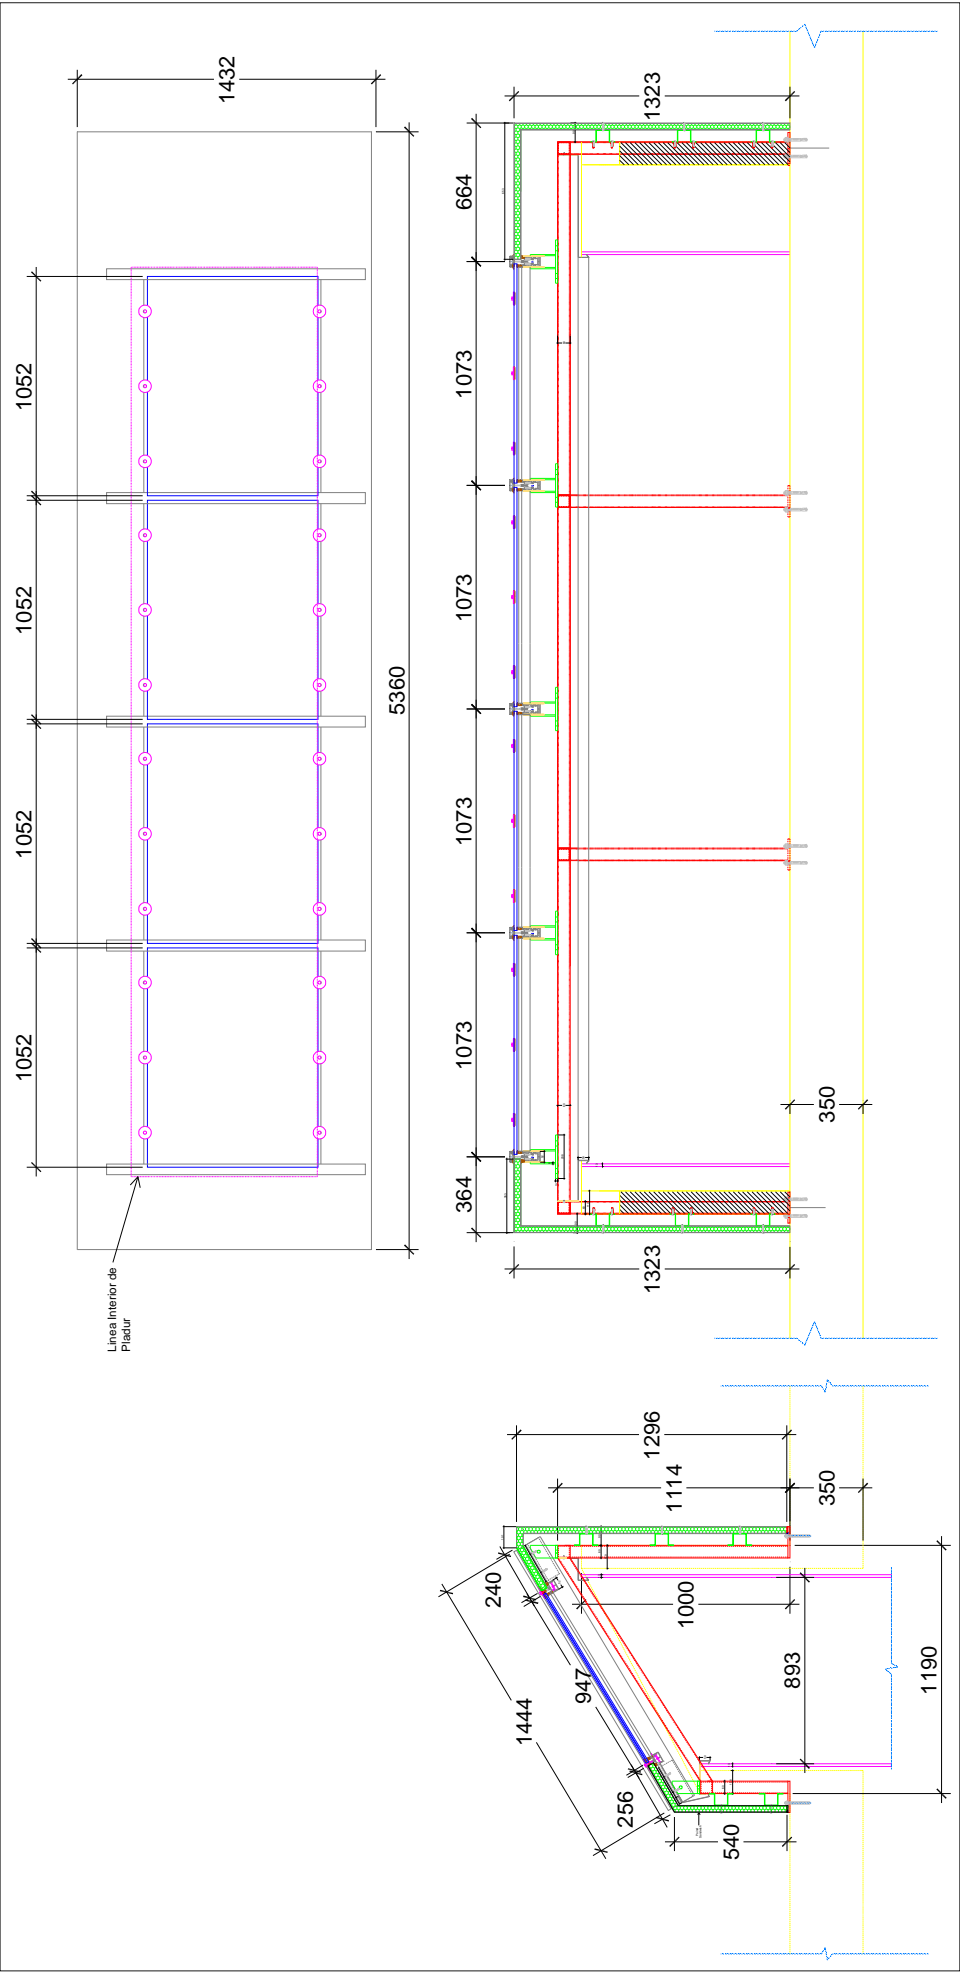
Planta, cortes longitudinal e transversal da clarabóia
